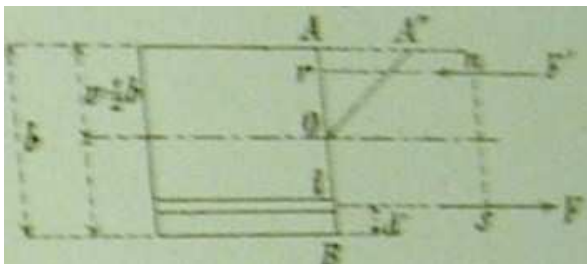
Diagrama de tensiones del hormigón armado propuesto por las normativas. (Marv, 1902)
